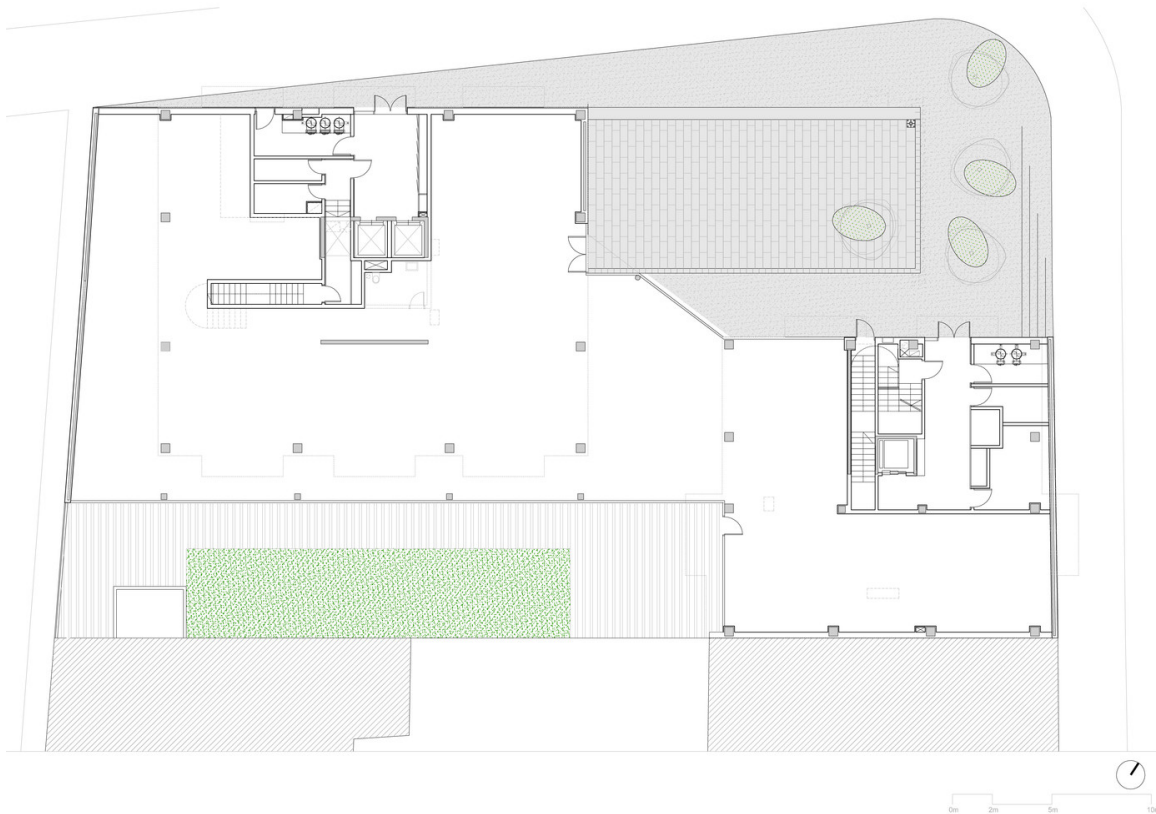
Planta Baja de Conjunto “Santa Madrona” Barcelona, España. Fuente: archdaily.mx
